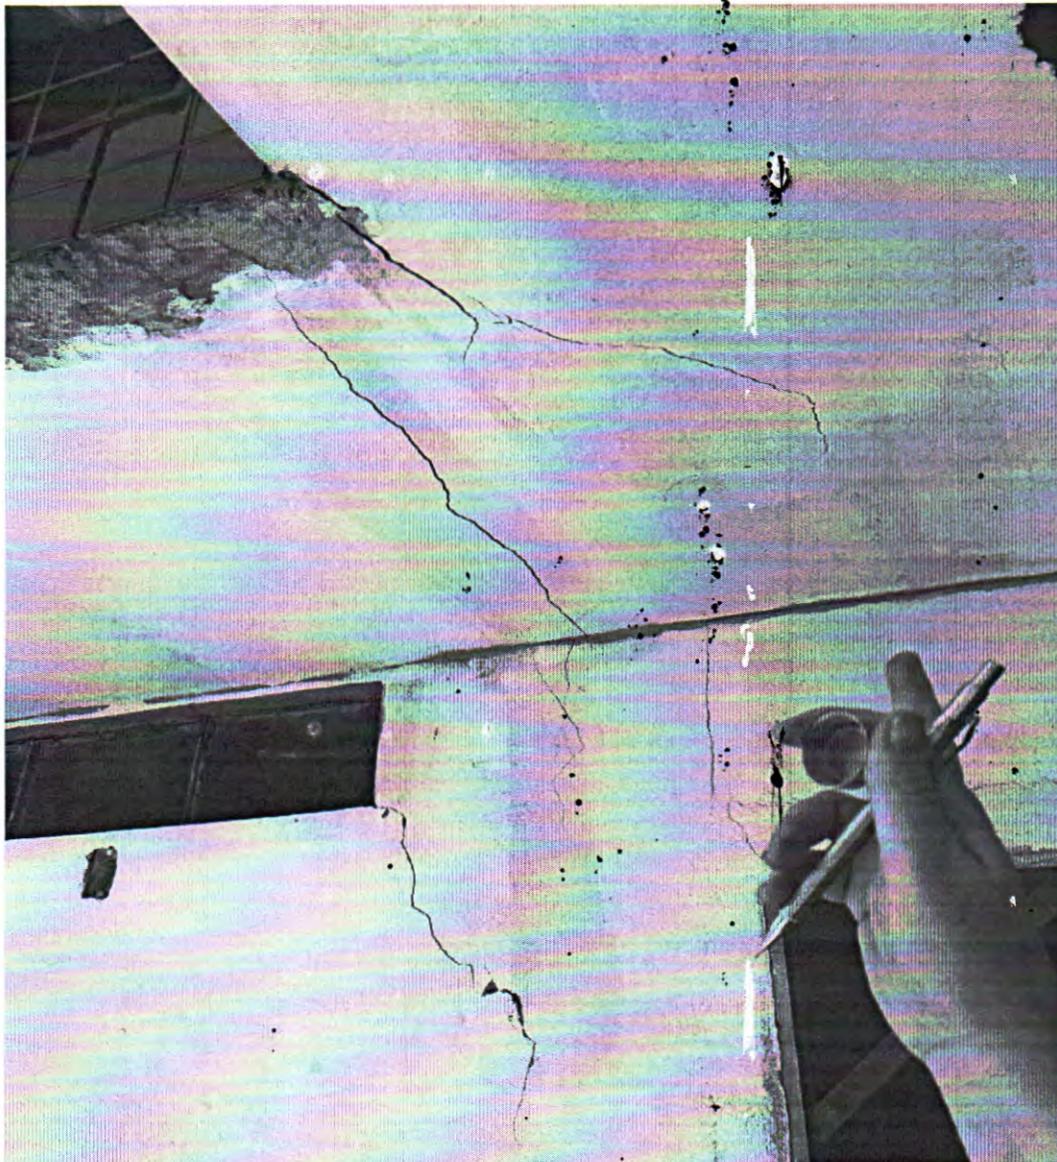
Trinca transversal na laje em balanço. Fonte: Acervo técnico
